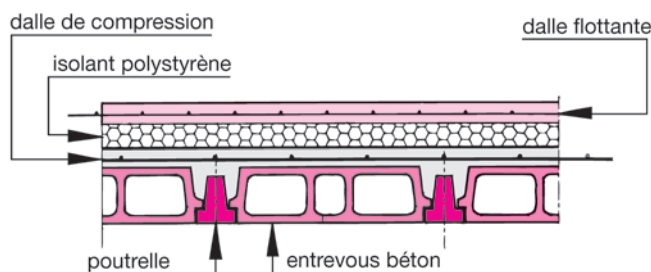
Plancher traditionnel d'étage avec dalle flottante sur isolant PSE
